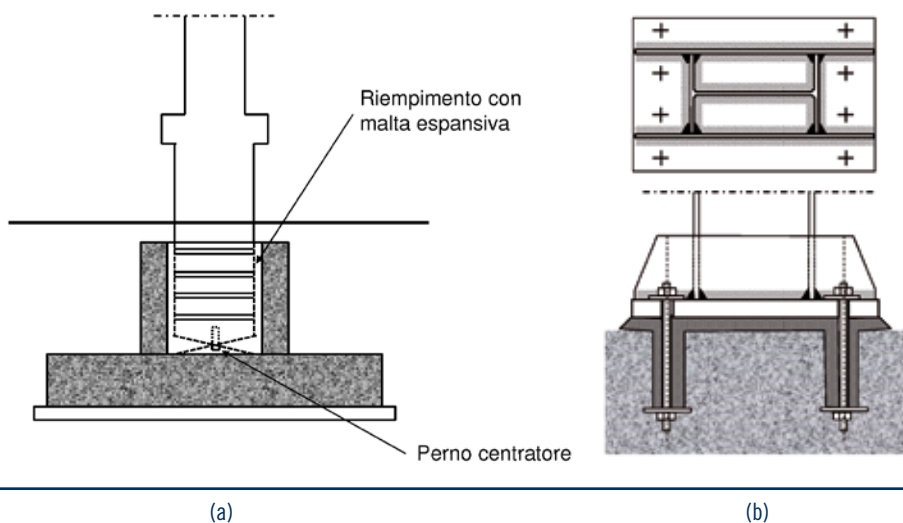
Connessione pilastro/parete – fondazione: a) plinto a bicchiere; b) connessione con piatto metallico e tirafondi con fazzoletti metallici di irrigidimento.
